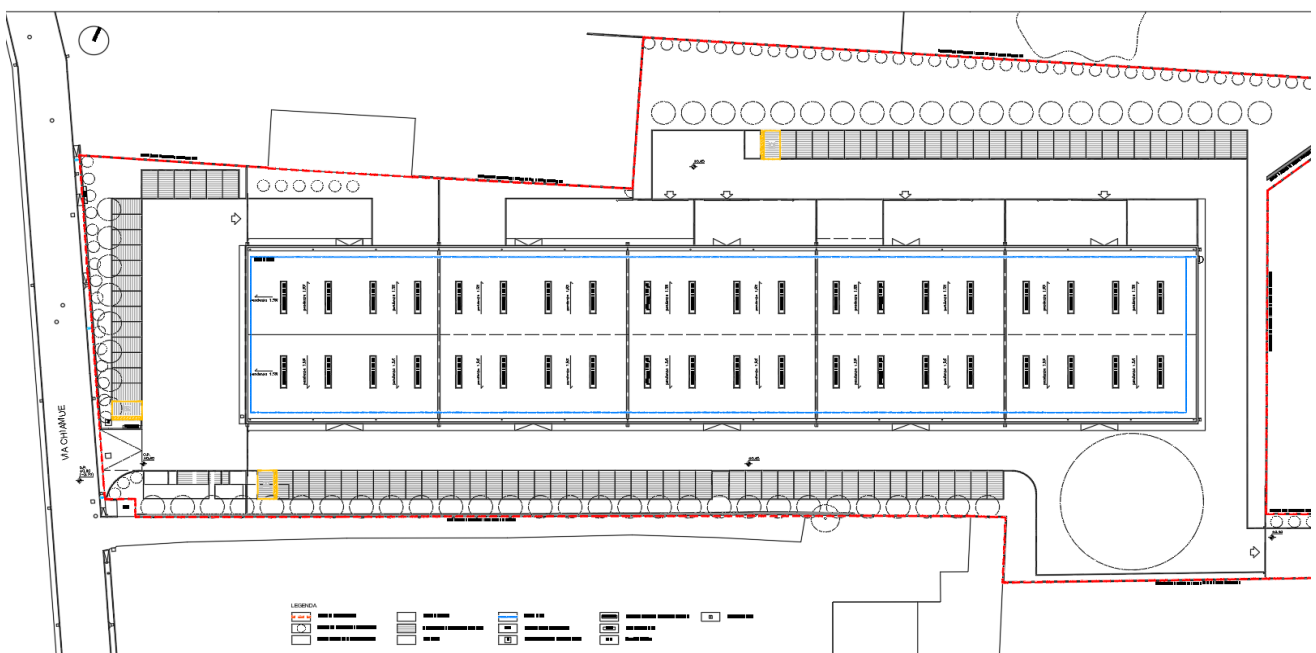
Estratto – progetto planimetria coperture e sistemazioni esterne
